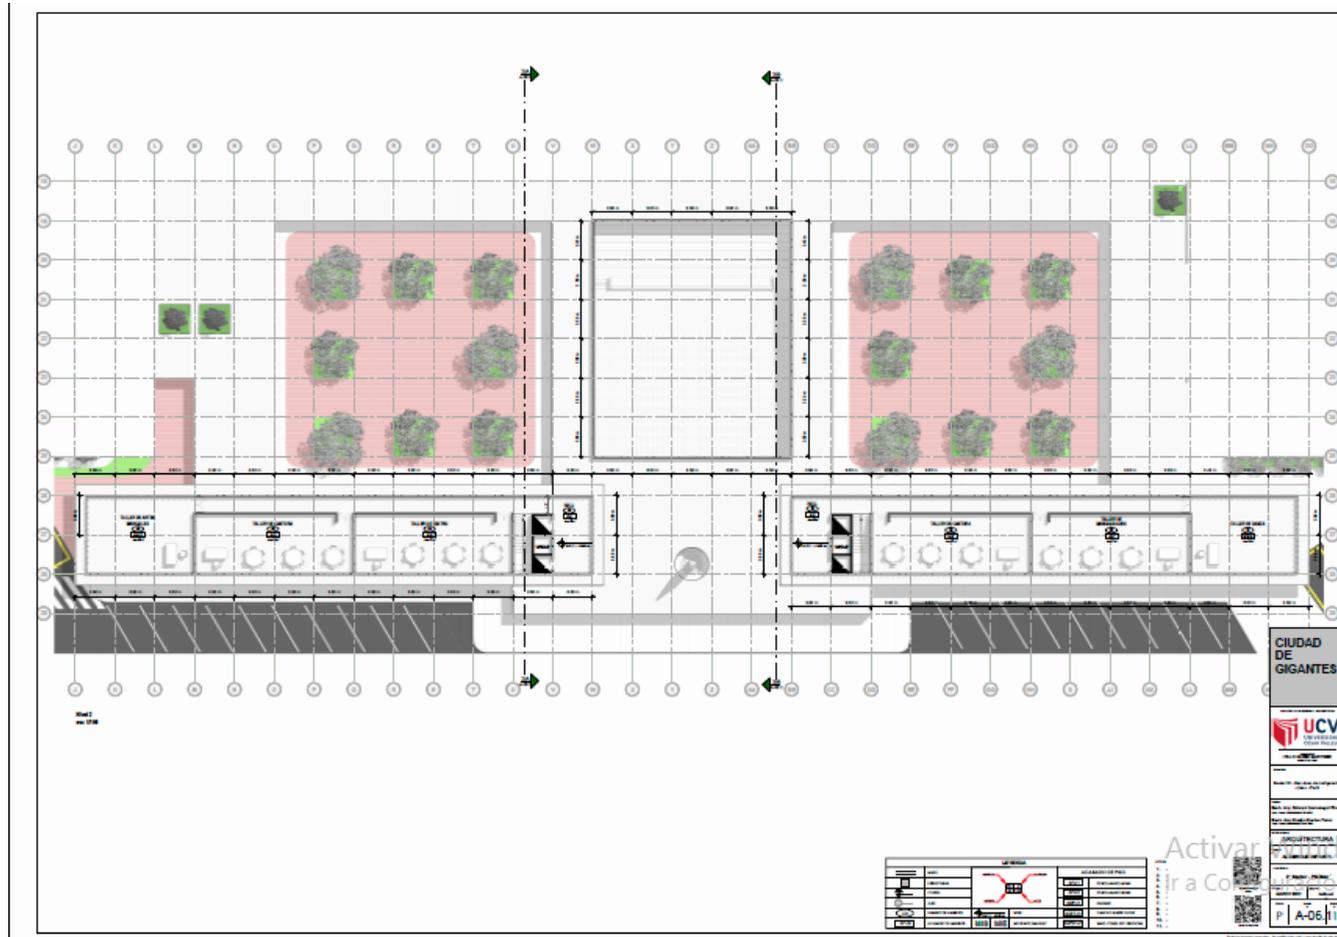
Plano de Planta Sector Servicios Complementarios - Segundo Nivel
